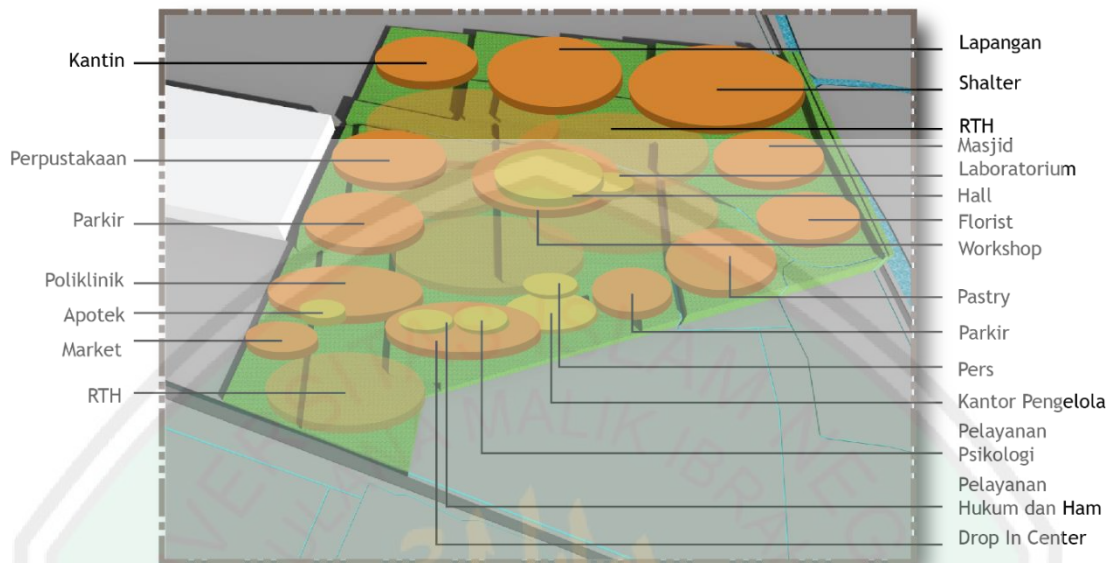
Gambar 4.46. Alternatif 1 Block Plan
